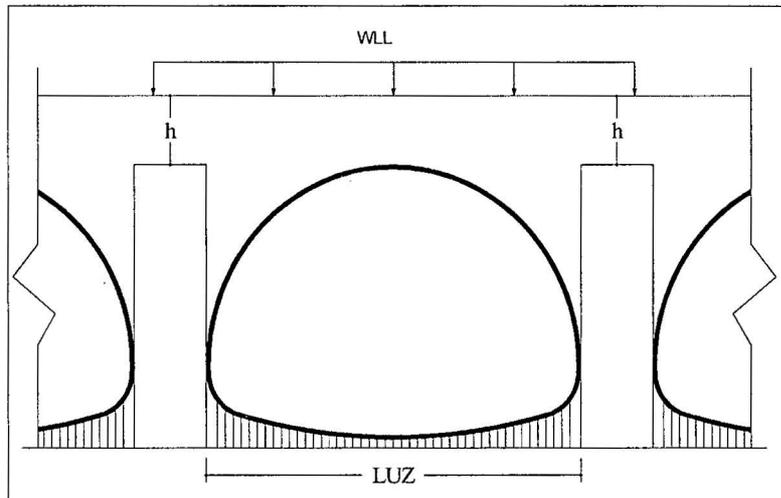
CARGA DE VÍA - SECCIÓN TRANSVERSAL
